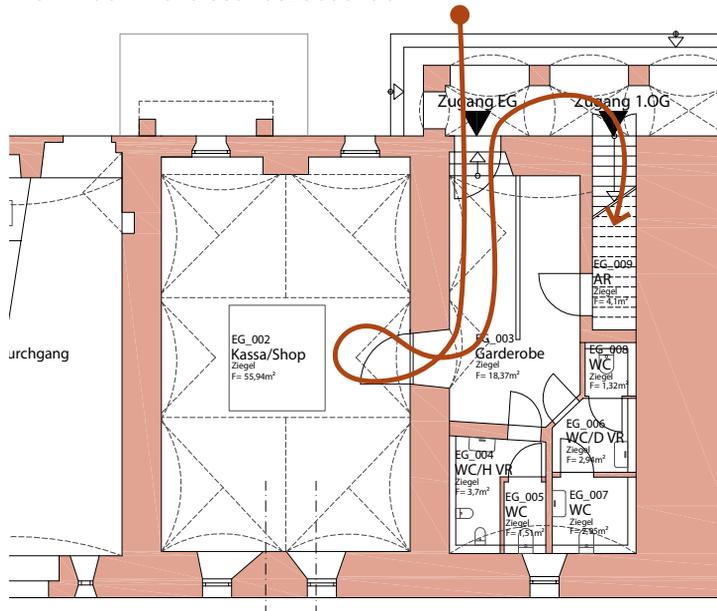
Planausschnitt: Eingangssituation im Erdgeschoss, o.M.
